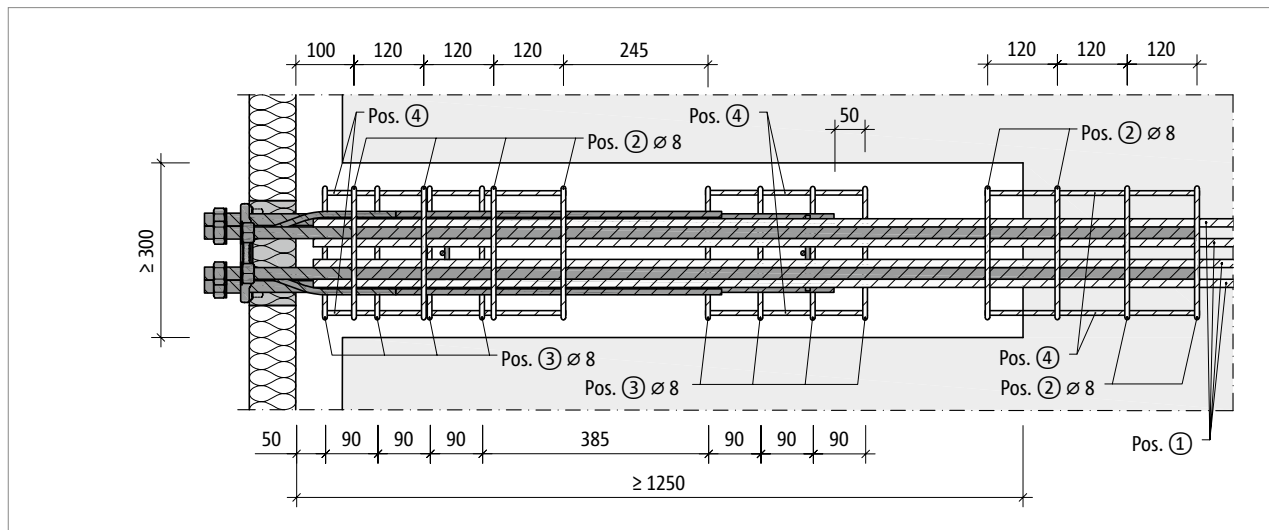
Schöck Isokorb® T type SK-MM2 : renforcement sur site pour mode de construction semi-préfabriqué, projection horizontale
